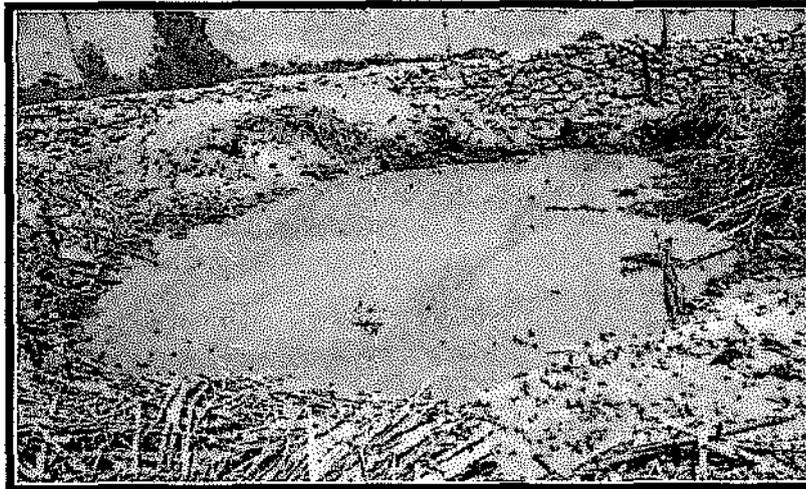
Parte baja de la Planta de Beneficio donde existe una segunda poza pequeña construido sobre suelo natural, sin criterio técnico, donde se almacenan las descargas que se producen por los rebalses y lavado de la Planta.
